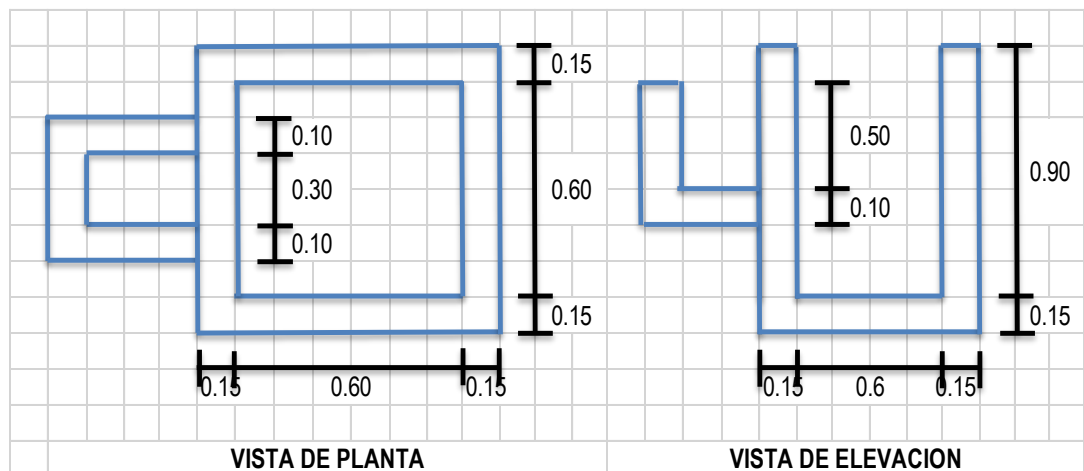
Dimensiones calculadas de las camaras rompersion proyectadas
